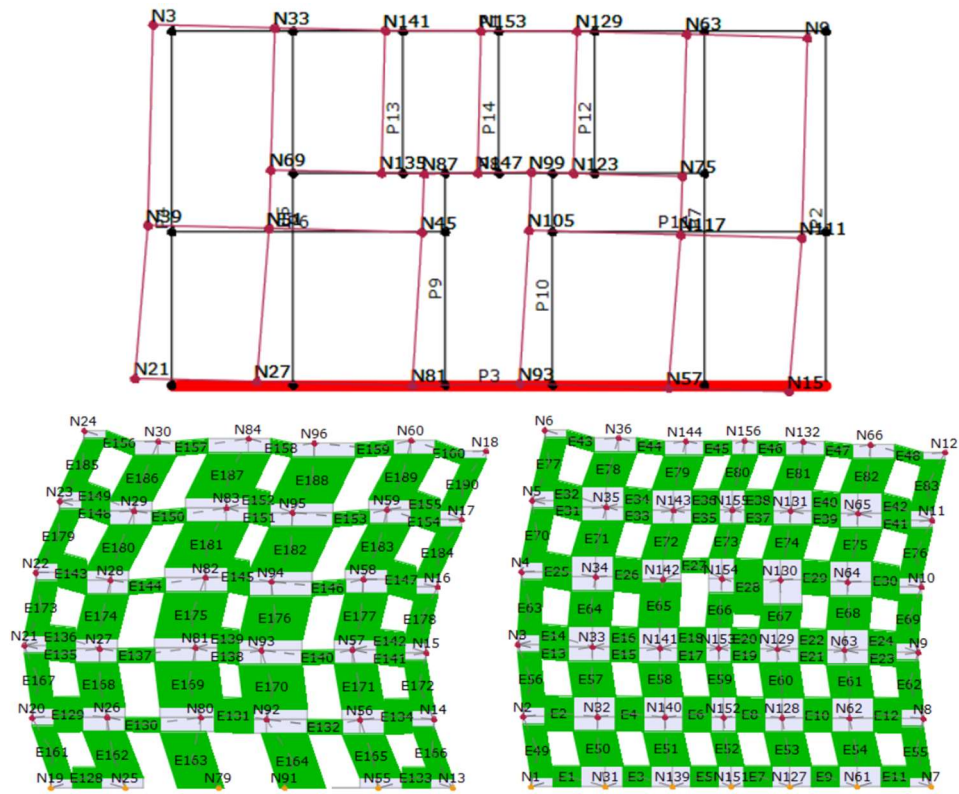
Sexto modo de vibração: Planta e alçados das paredes WX5 e WX1
